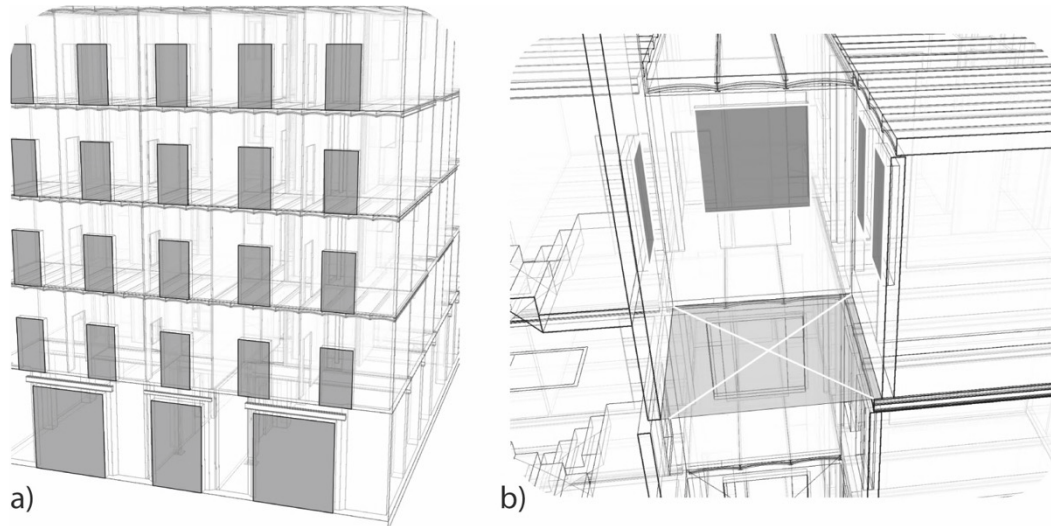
Aperturas en a) fachada frontal, y b) patio interno (fuente: preparado por el autor)
